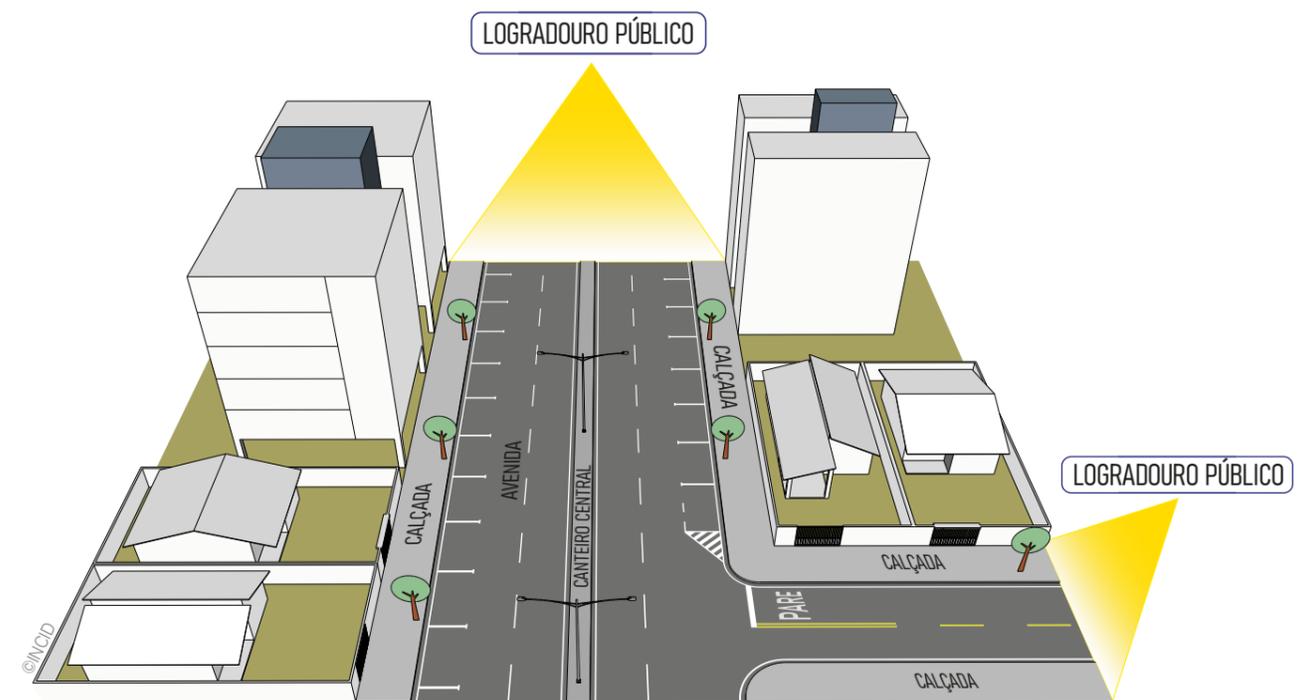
LOGRADOURO PÚBLICO (calçadas, ruas, avenidas, canteiros centrais, etc.)
